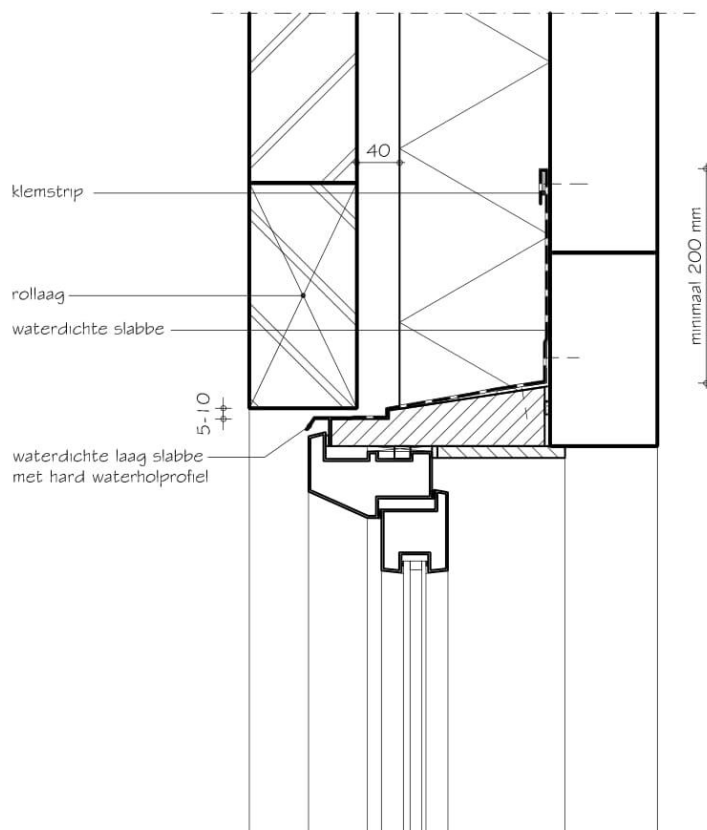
Kozijnaansluiting bovendorpel met zelfdragende latei
